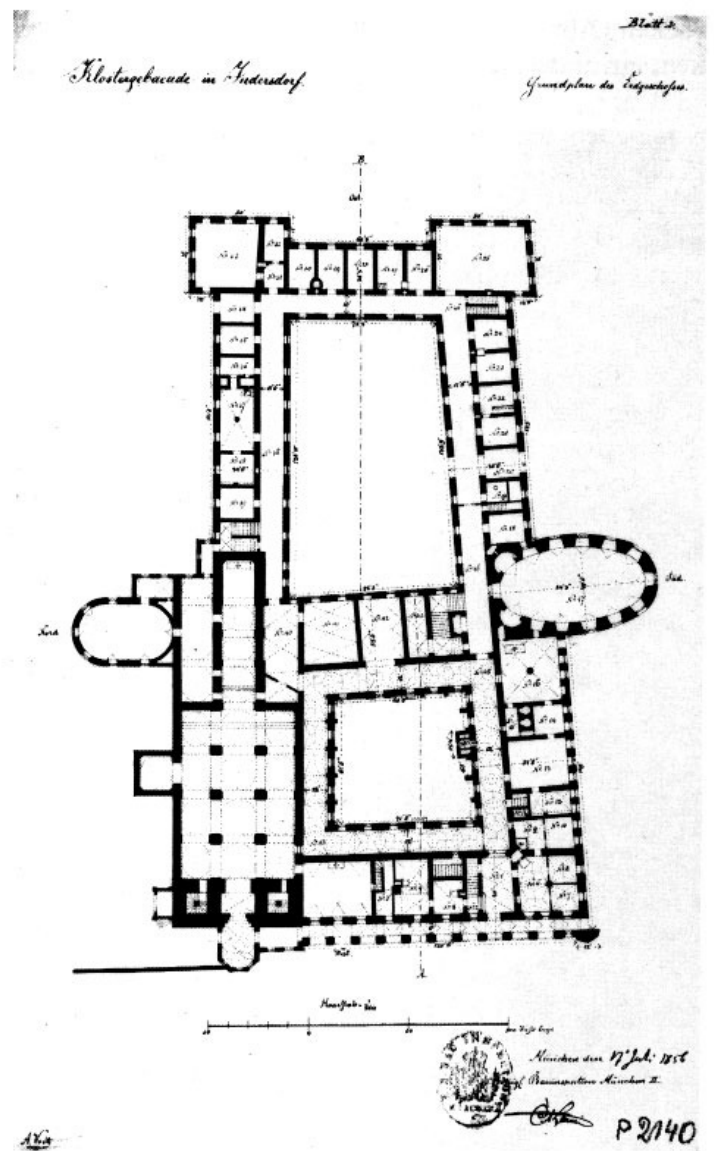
Kloster Indersdorf, Grundriß des Erdgeschosses von 1856, StA München, Plansammlung 2140. Foto: Staatsarchiv München
